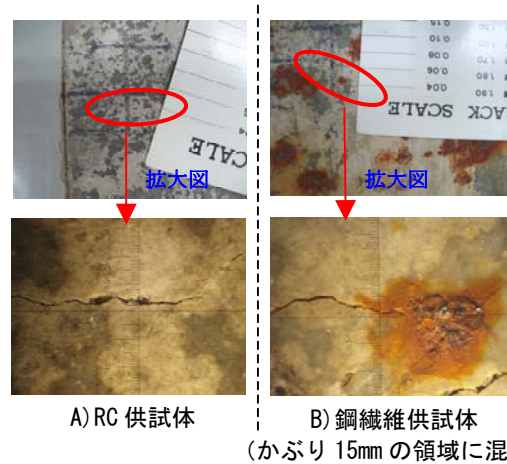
95 サイクル後のコンクリートひび割れ状況
